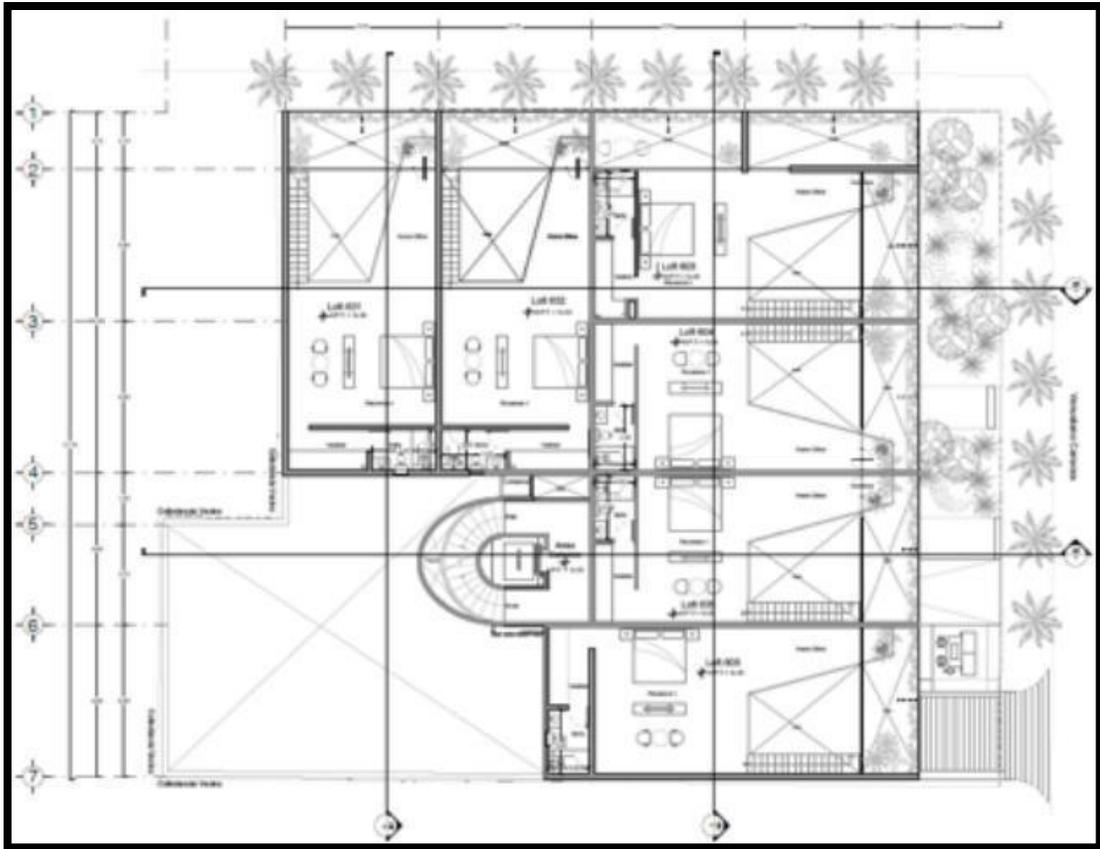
Planta de Sexto nivel (N6), Loft Planta alta
